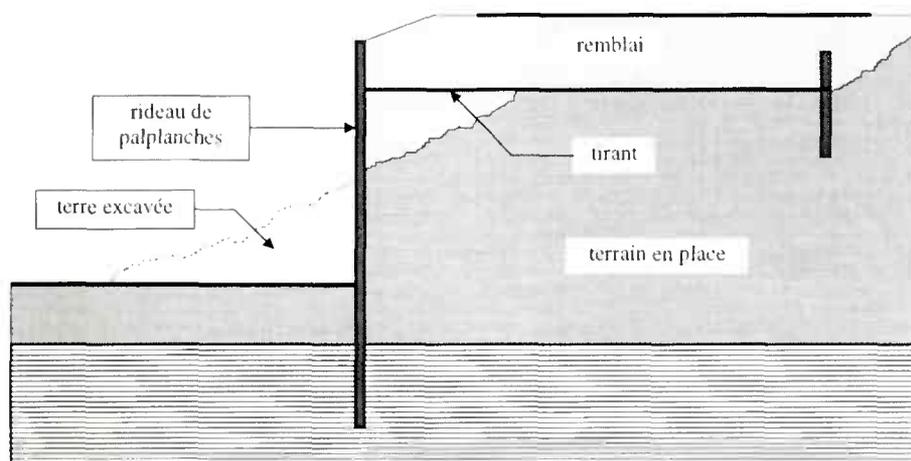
Ouvrage mixte remblai-déblai (exemple)
